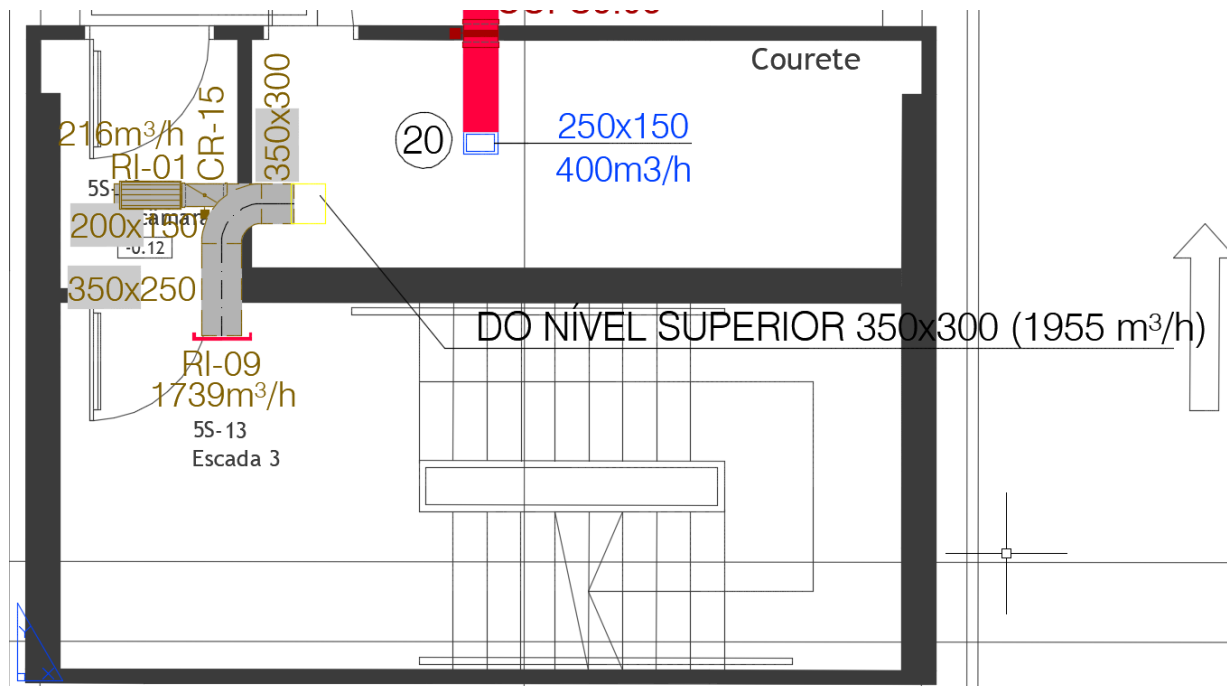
Caixa de escada 3, em planta, do piso -5 – HCD Expansão
